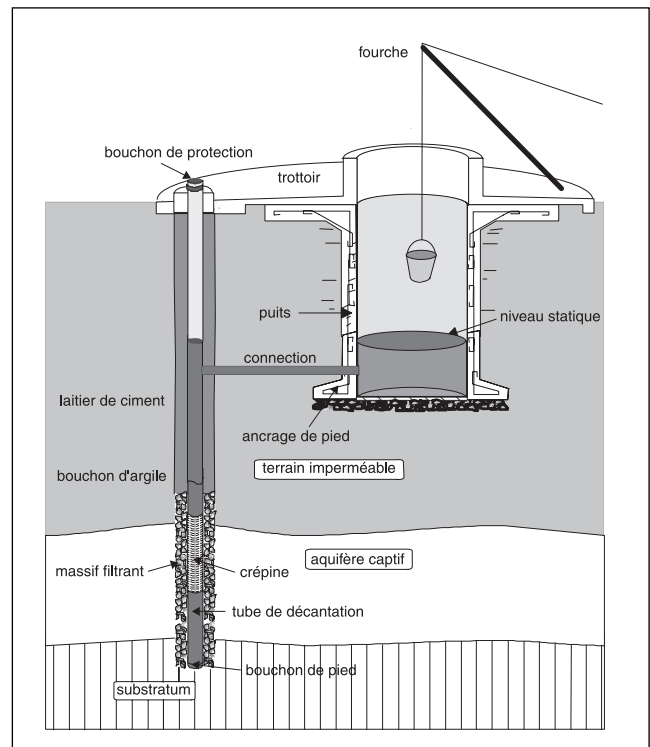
Puits sur forage latéral (ACF, Mali, 2003).
